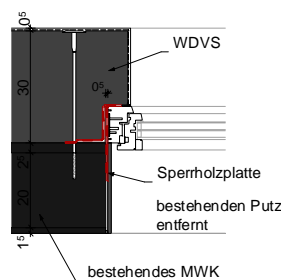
Detailausbildung der einzelnen Profil und Einbauvarianten
